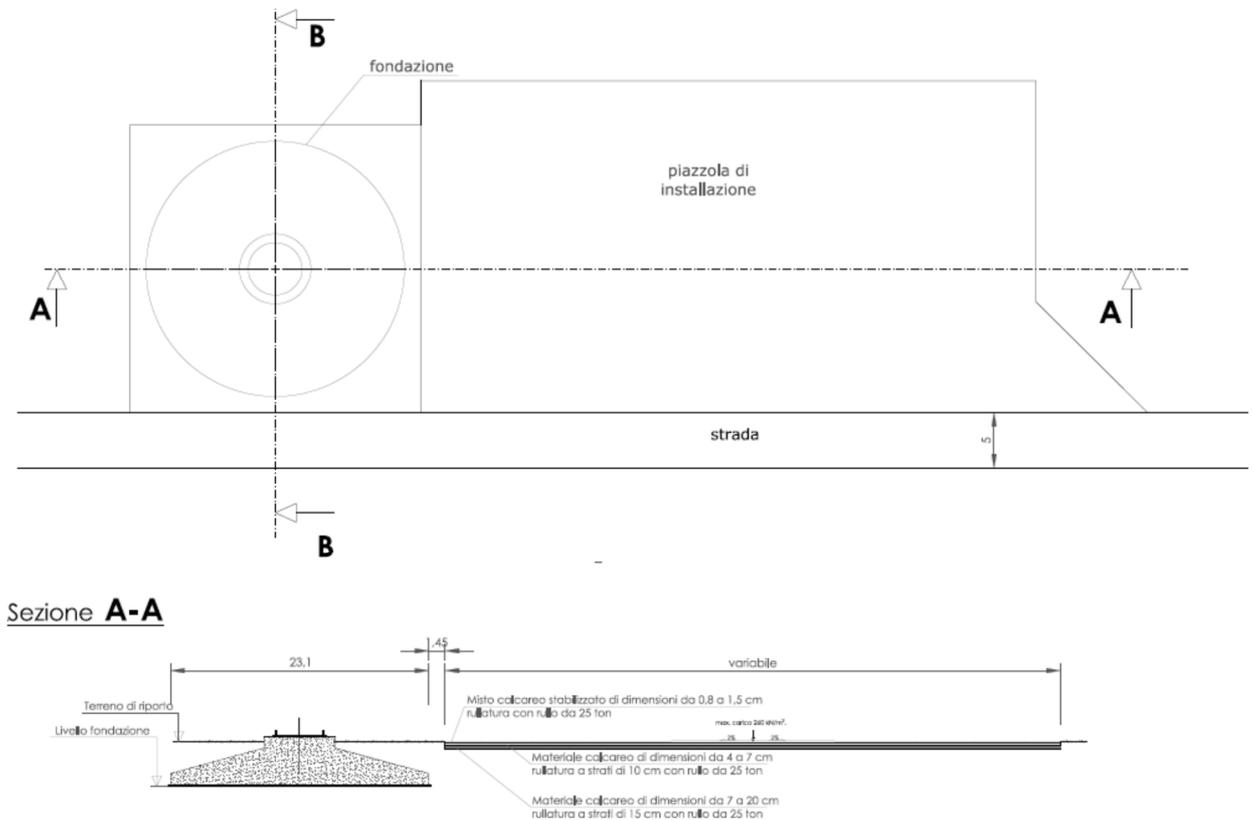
Pianta e sezione della piazzola e della fondazione di un aerogeneratore tipo
